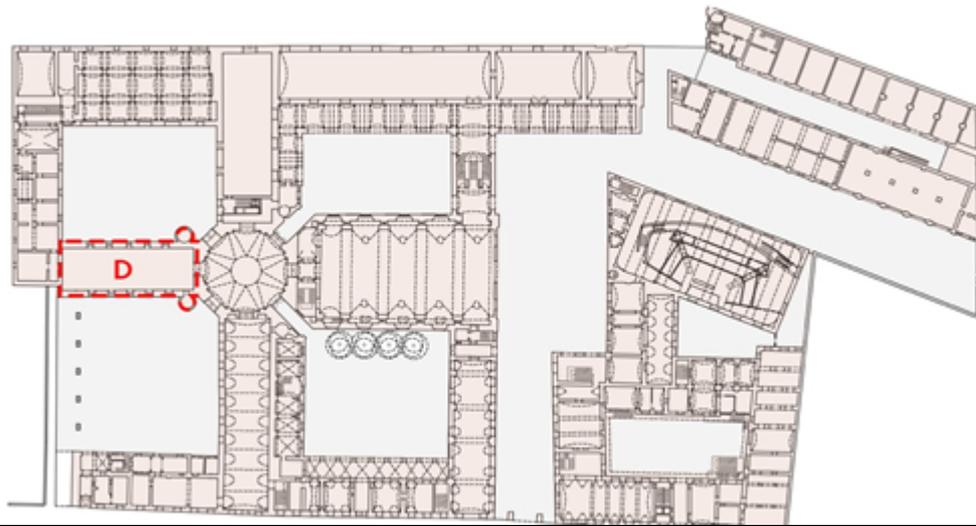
planimetria con evidenza edificio D - elaborazione personale
